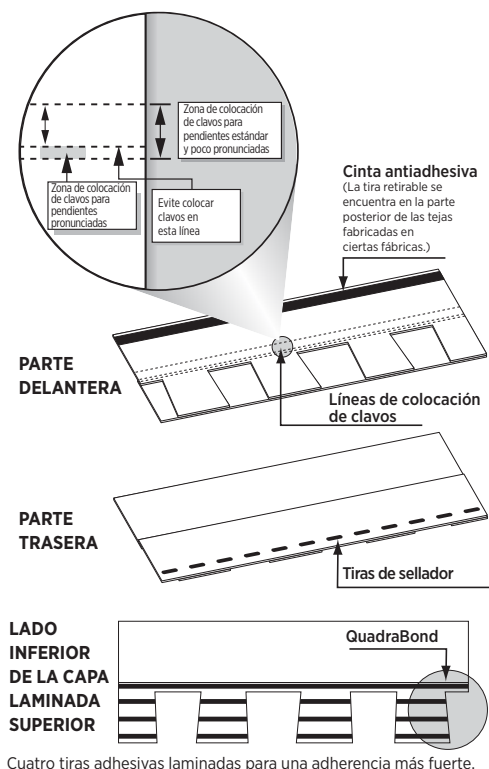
NailTrak® presenta un área de clavado más amplia y una construcción QuadraBond más fuerte.
